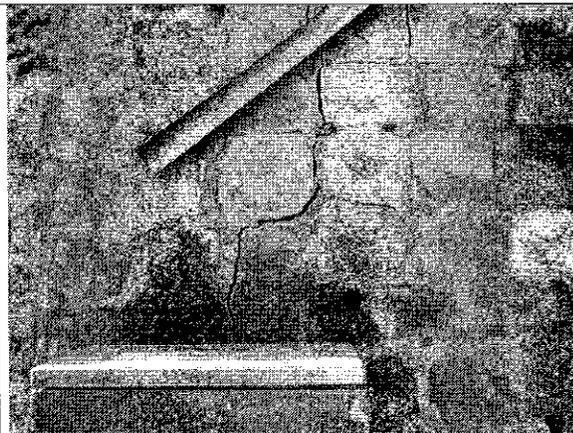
Deterioro progresivo del muro y apuntalamiento.
